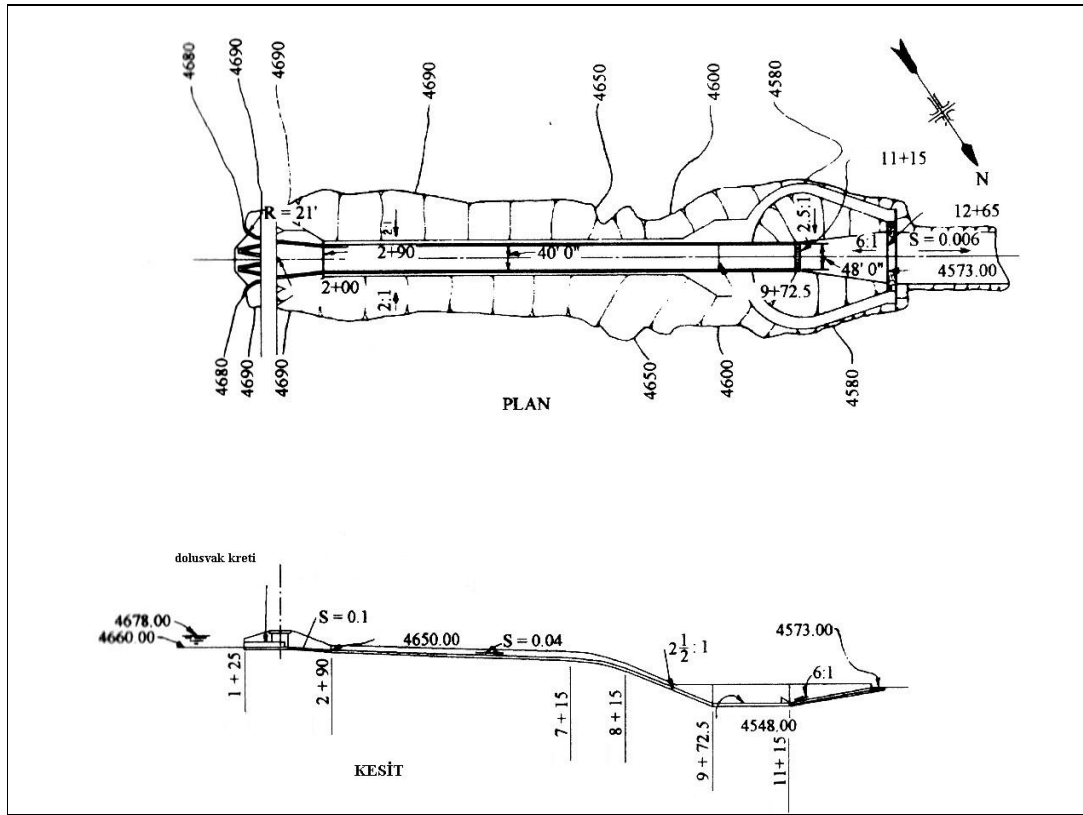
Avon Barajı Labirent Dolusavak Yerleşim Planı ve Savak Detayı [52]
